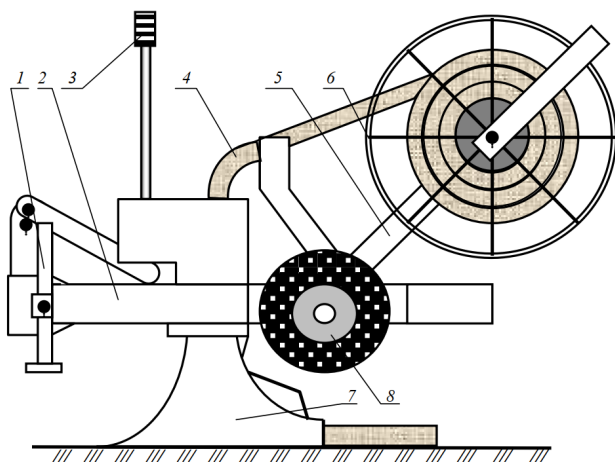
Схема оборудования МДИ: 1 – дополнительная опора; 2 – рама; 3 – приемник лазерного луча; 4 – дренажная труба; 5 – стойка; 6 – барабан; 7 – нож; 8 – колесная опора
